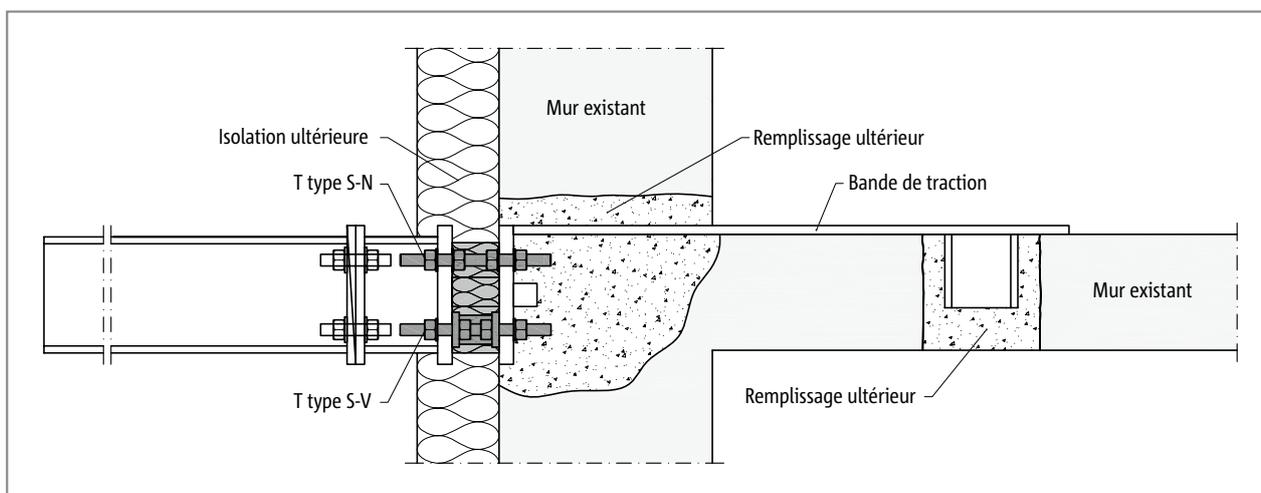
Schöck Isokorb® T type S-N et T type S-V : balcon en acier avec adaptateur, en porte-à-faux, posé ultérieurement ; relié à la dalle en béton armé existante par une bande de traction
